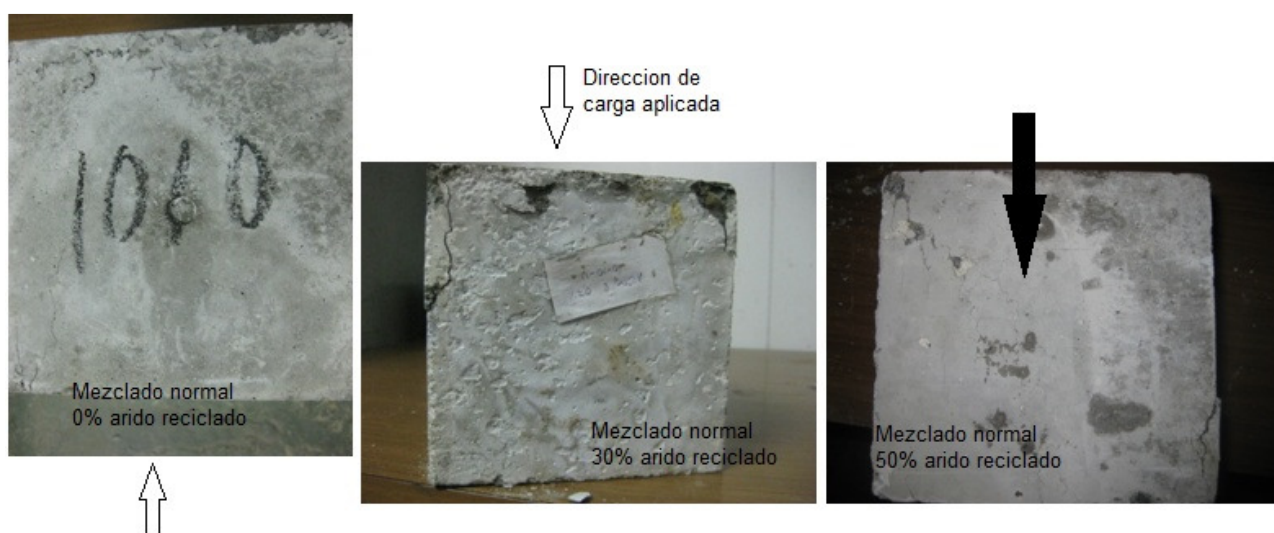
Fisuras del cubo patrón - mezclado normal
